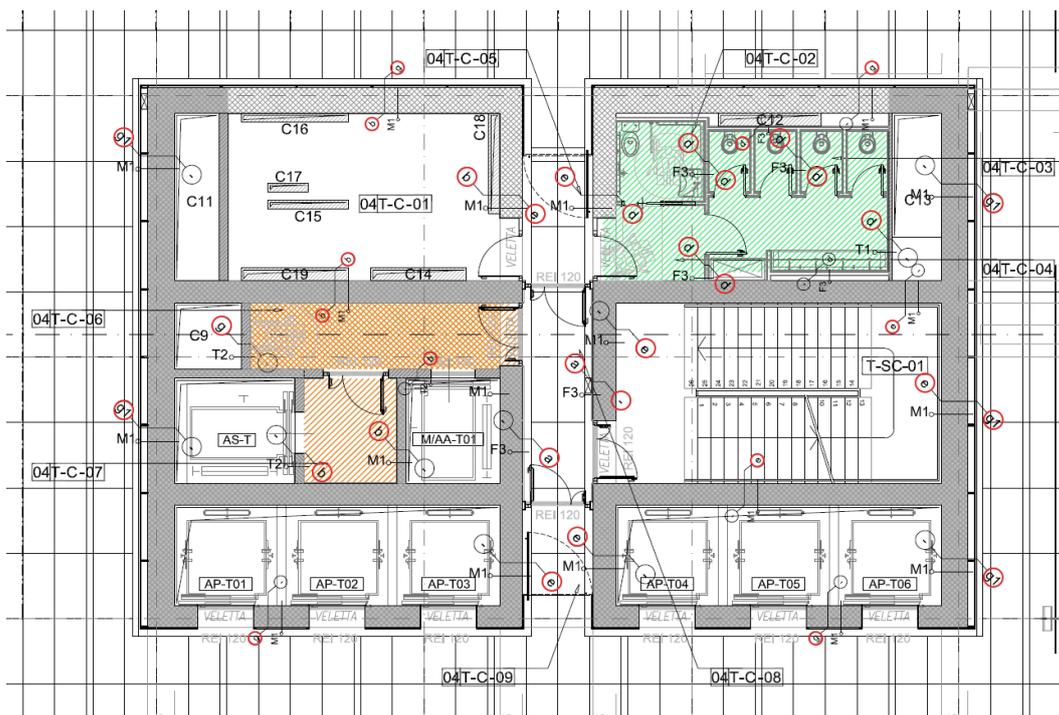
stralcio di pianta piano 4 - individuazione finiture
